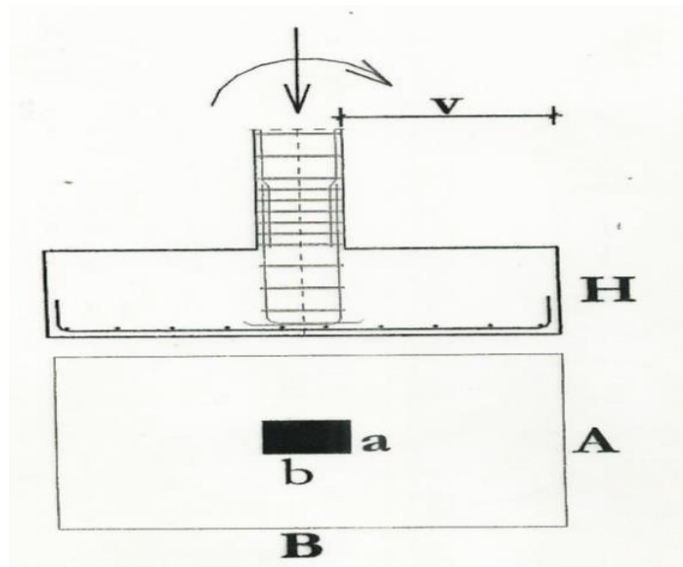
Sapata rígida. (Fonte: Apontamentos de betão)
